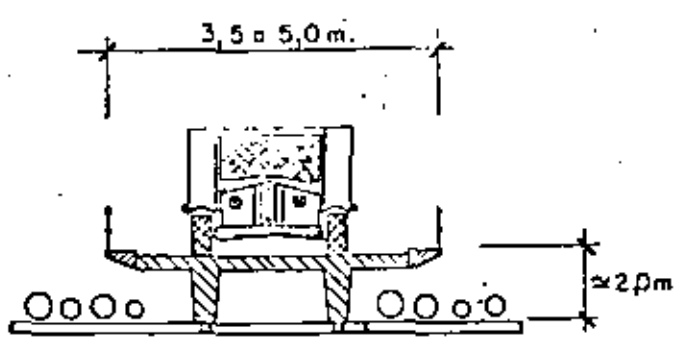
SECCION TIPICA ACCESO PRINCIPAL
